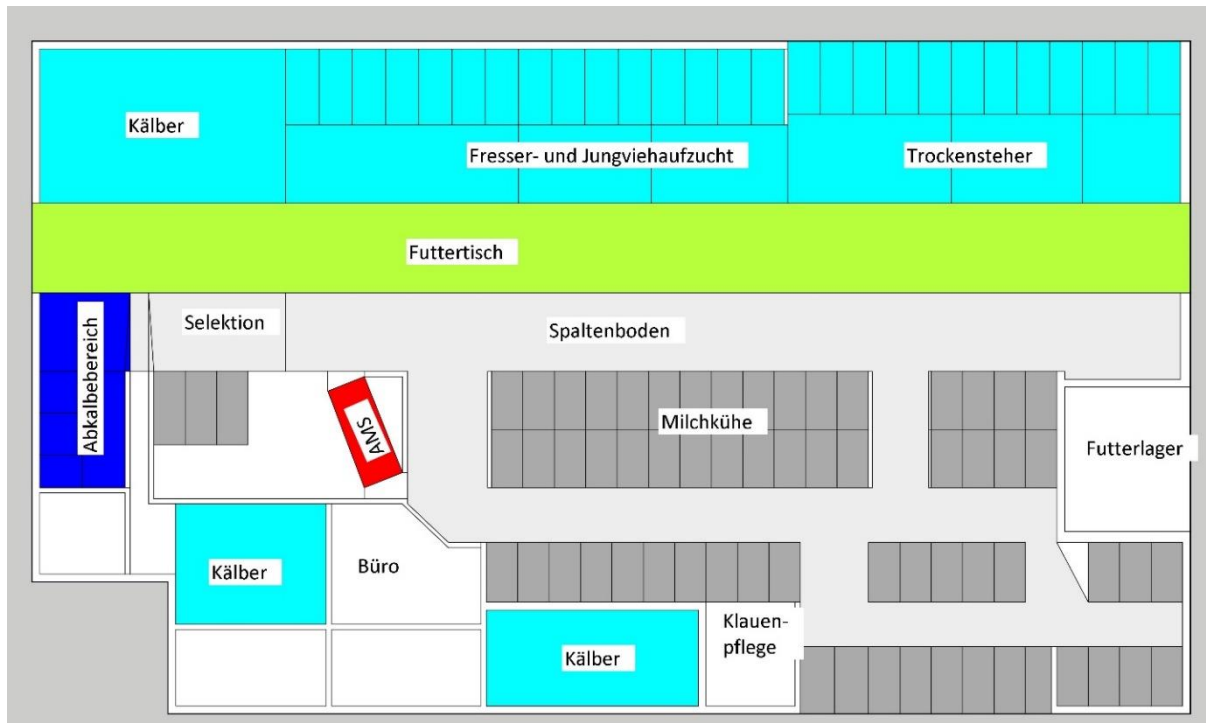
Gebäudegrundriss und Raumprogramm vor den Umbaumaßnahmen
